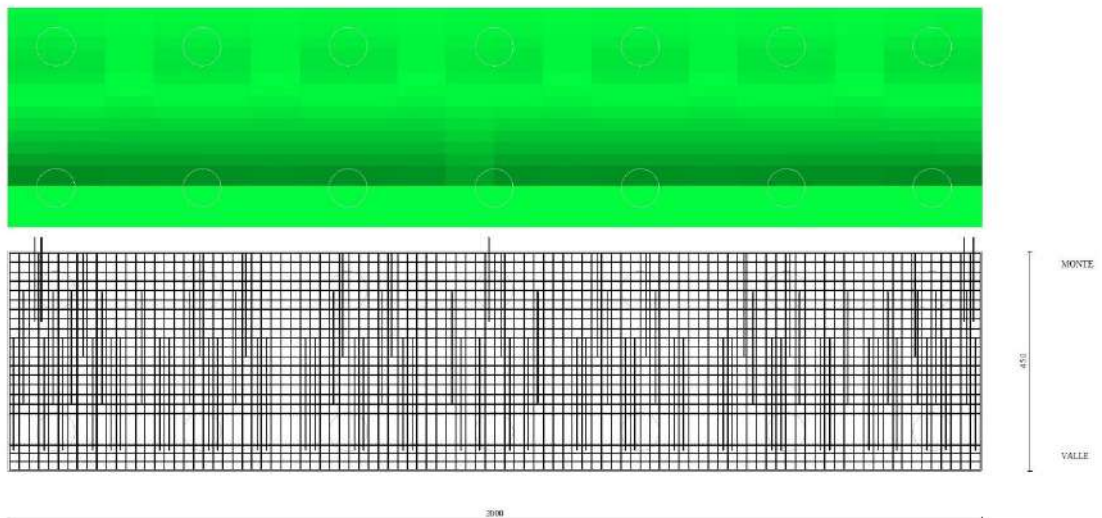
Piastra fondazione dir. Y (Inviluppo)
